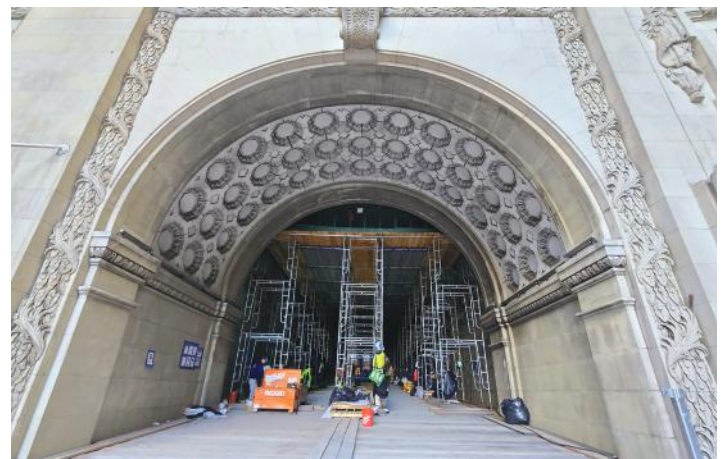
Un sistema de plataforma suspendida instalado a 1.8 m (6 ft) por debajo del techo del viaducto permitió que las obras de restauración avanzaran sin interrumpir el tráfico (foto cortesía de Thornton Tomasetti)
